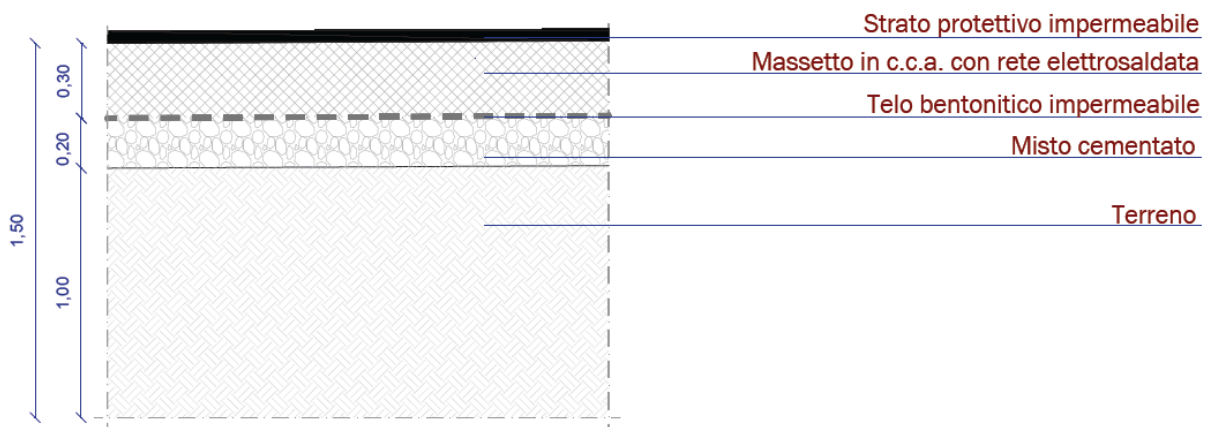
Dettaglio pavimentazione superfici esterne al piazzale.
